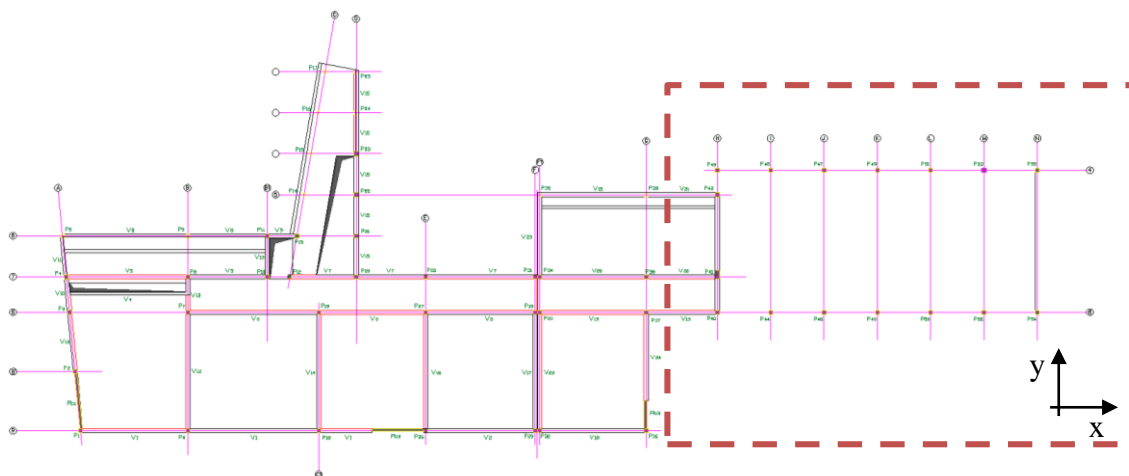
Implantação do edifício escolar, com indicação da zona em estudo.
